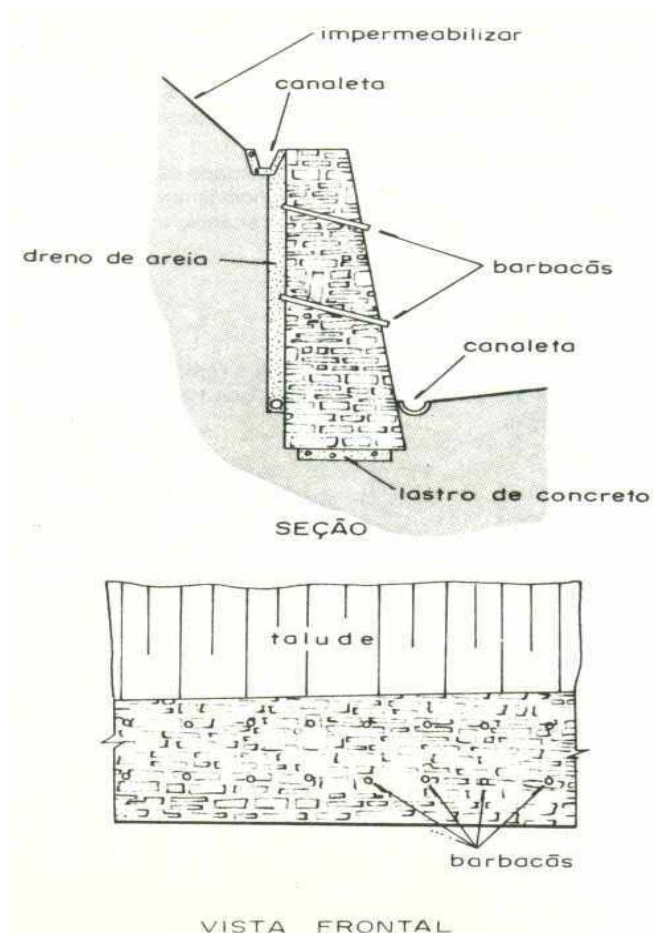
Muro de pedra Argamassada (CUNHA, 1991)
